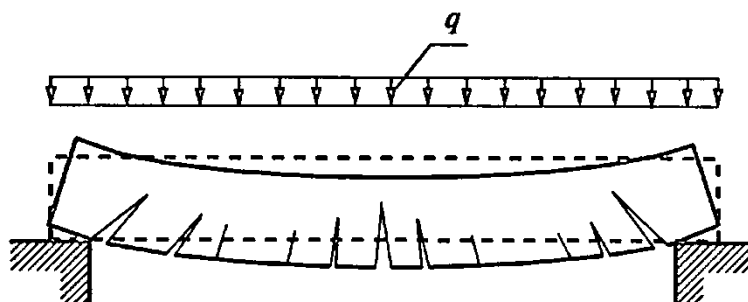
Схема разрушения железобетонной балки (арматура условно не показана)
